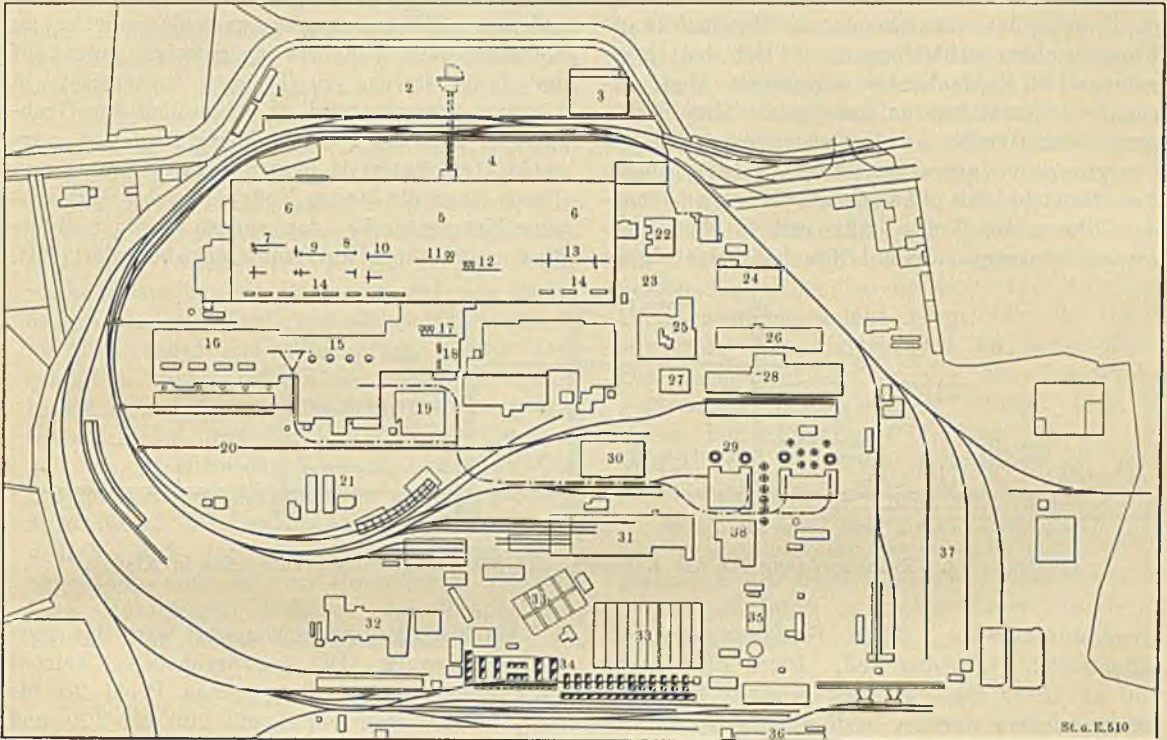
Lageplan des Eisenwerkes Kladno.
